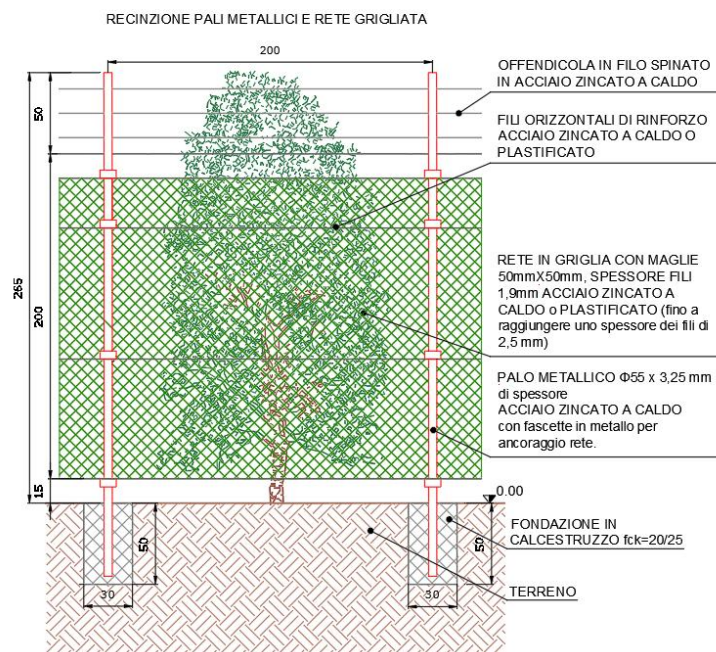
Dettaglio prospettico recinzione perimetrale: recinzione verde di tipologia leggera con pali metallici e rete grigliata con olivi della cv FS-17 (favolosa)
